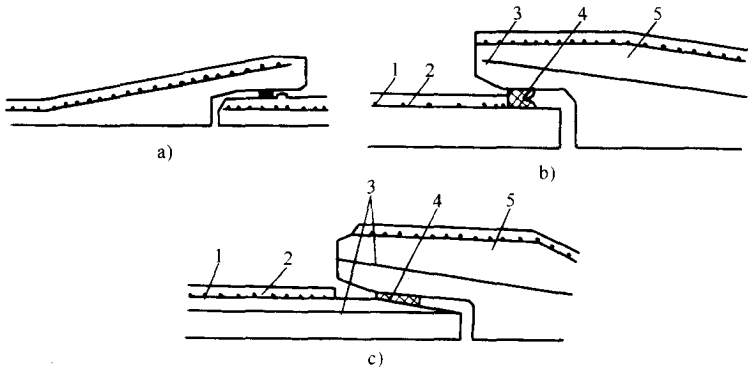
预应力、自应力钢筋混凝土管承插式柔性接口示意图
